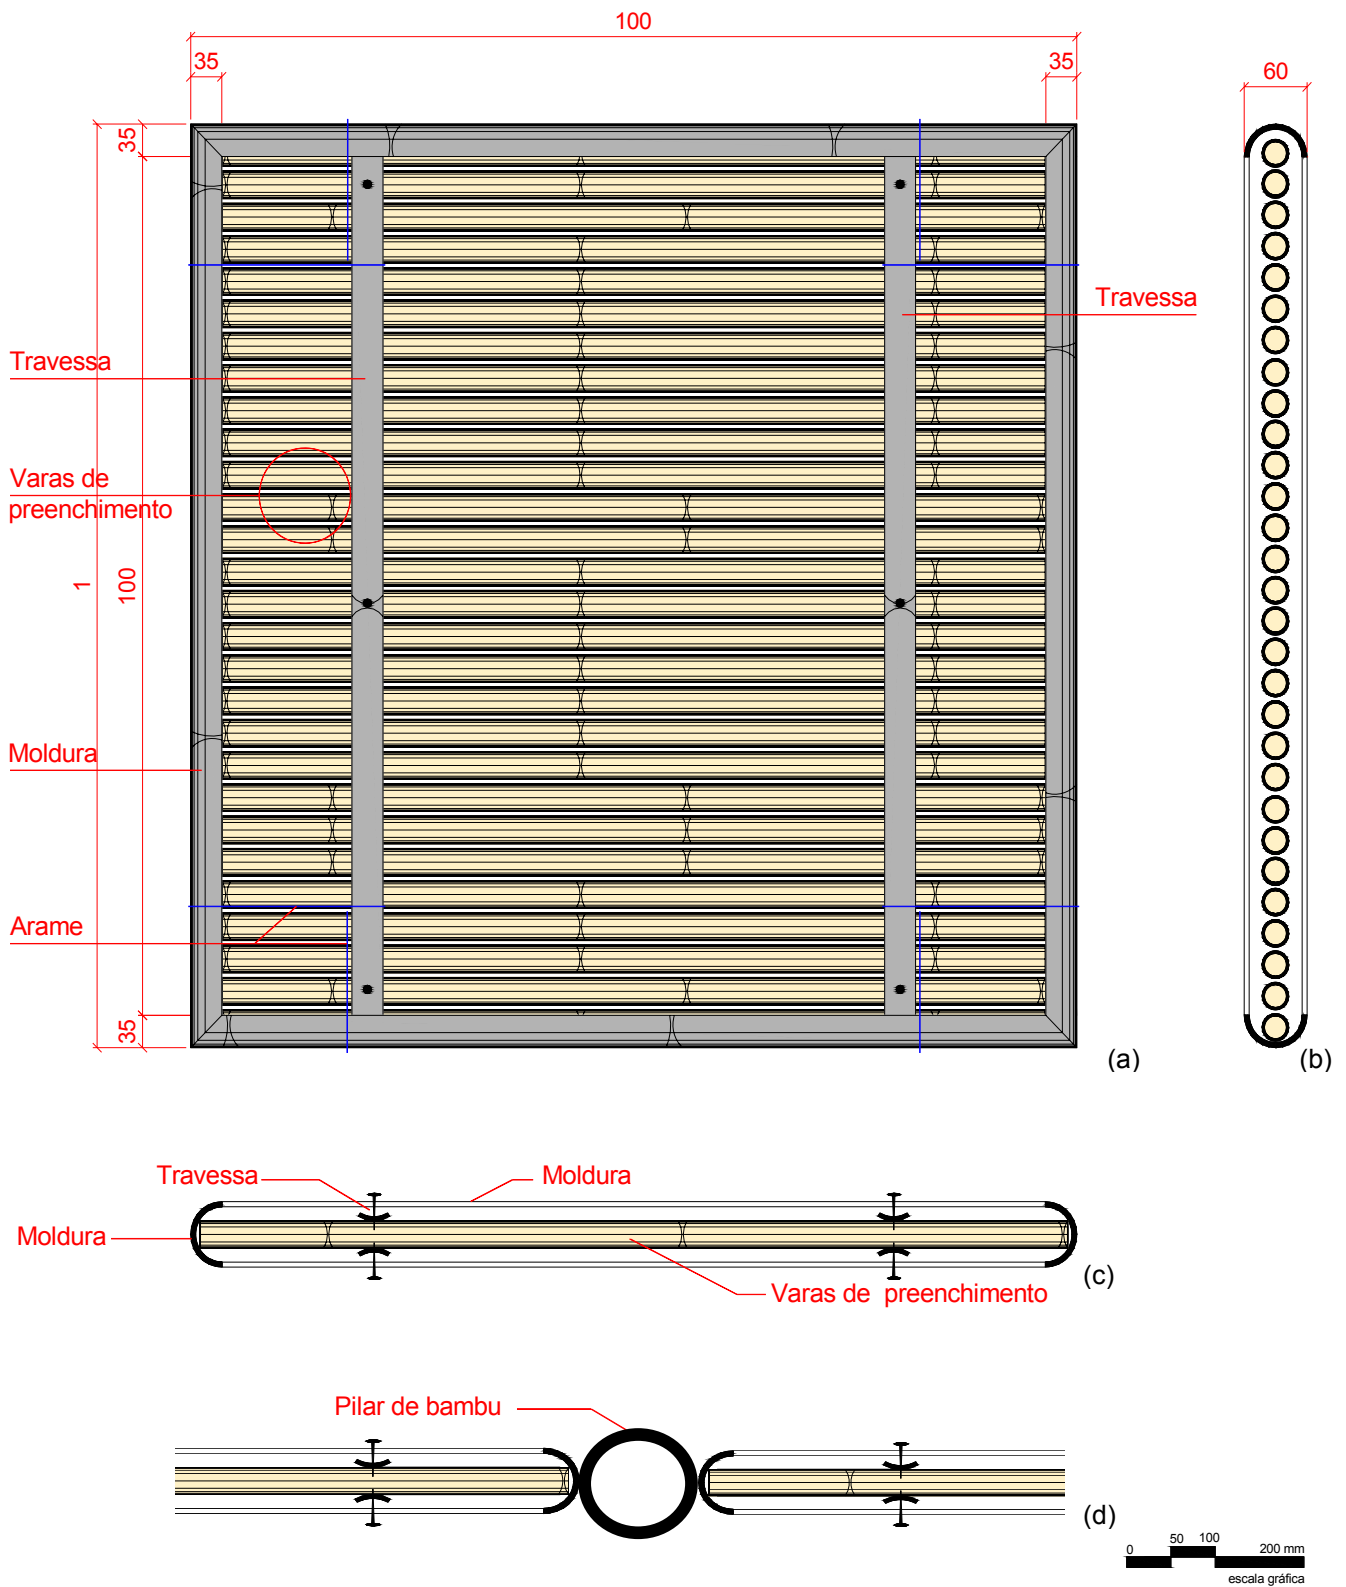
Estrutura de bambu do corpo-de-prova, apresentado da seguinte forma: (a) Vista frontal; (b) Corte longitudinal; (c) Corte transversal; (d) Detalhe do encontro dos painéis com o pilar de bambu, em corte.
